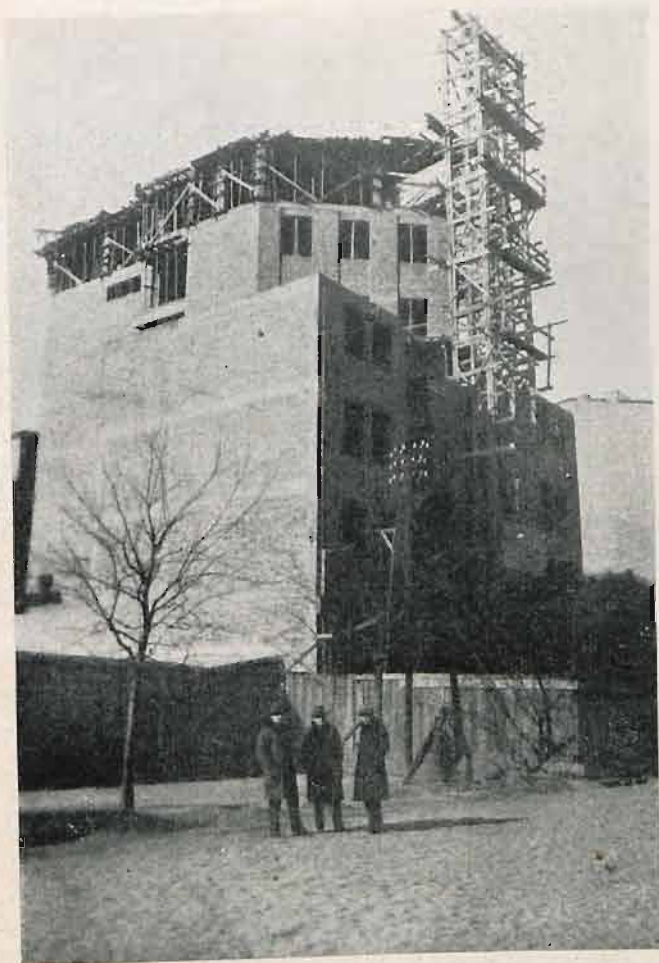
Gmach P. Z. U. W. w Łodzi.
